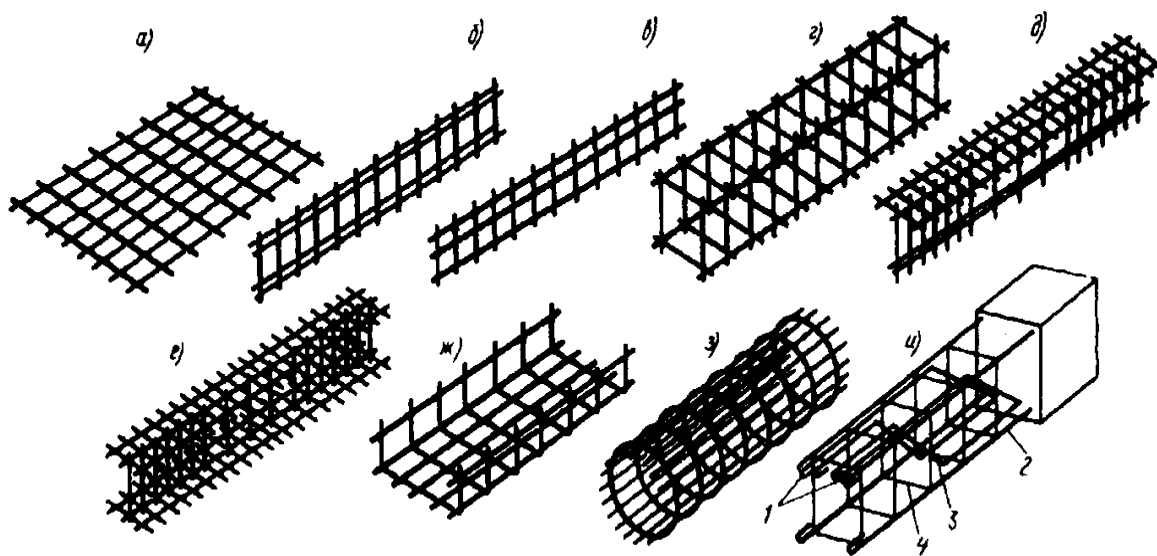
Основные конструкции железобетонной металлической арматуры
